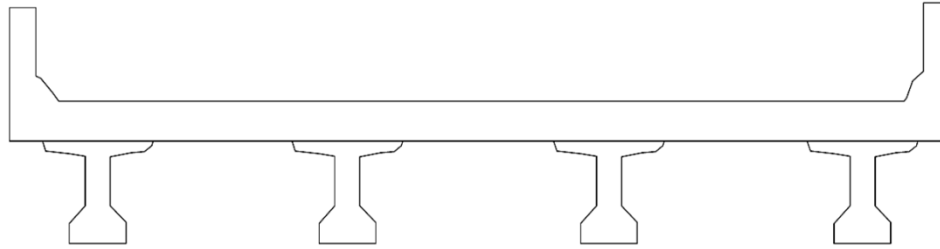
Sección transversal de puente con vigas doble T o tipo I (AASHTO, 2007).
